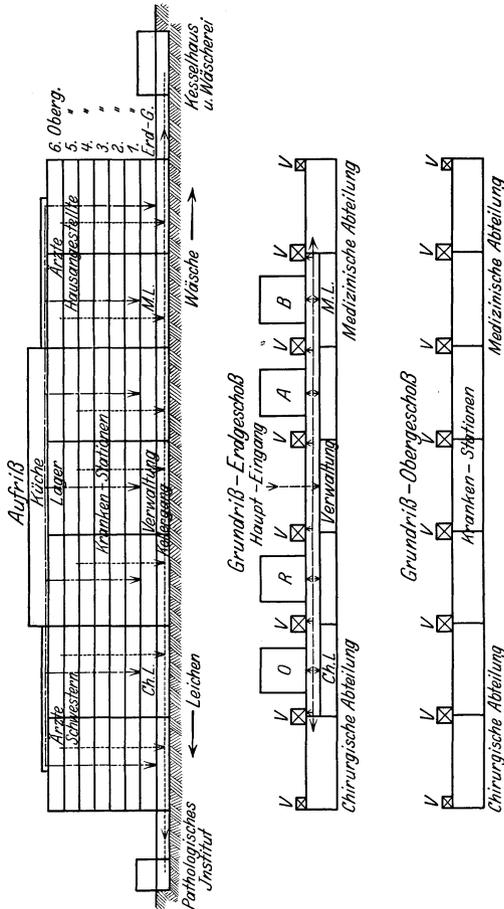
Schematischer Plan eines langgestreckten Krankenhaushochhauses.
